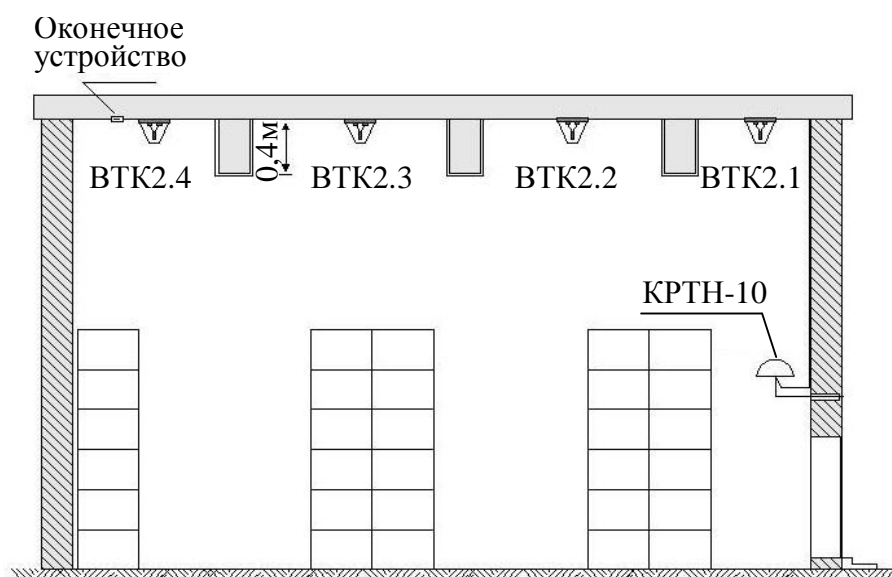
Размещение АПИ на потолке помещения с выступающими ребрами перекрытия
